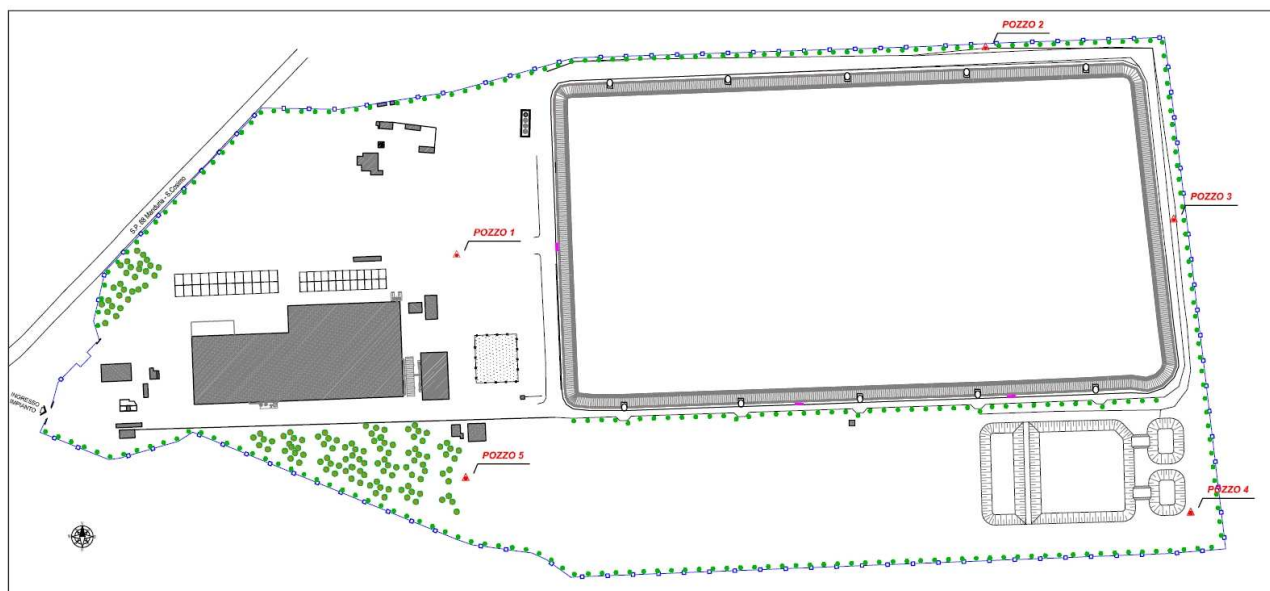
Planimetria del sito con ubicazione dei piezometri di monitoraggio esistenti
